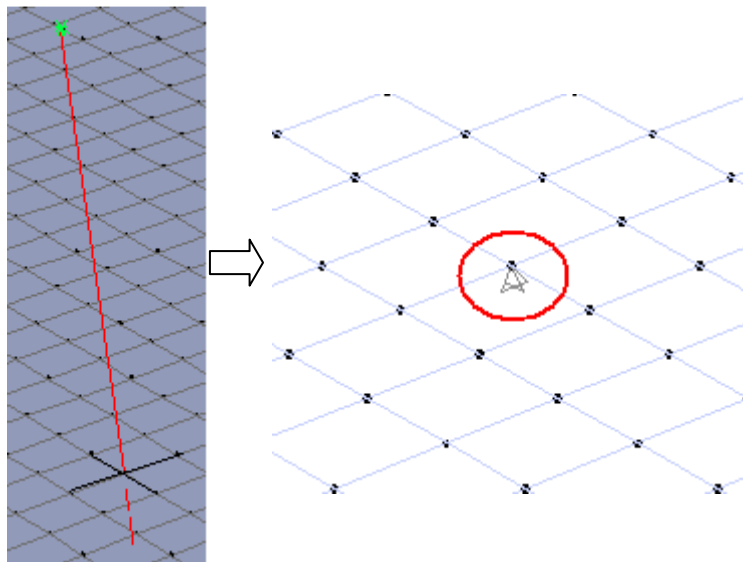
Pilar modelado como barra substituído por um apoio do segundo gênero
